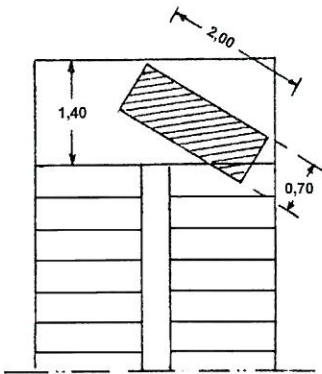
Dimensões mínimas para o transporte de móveis
